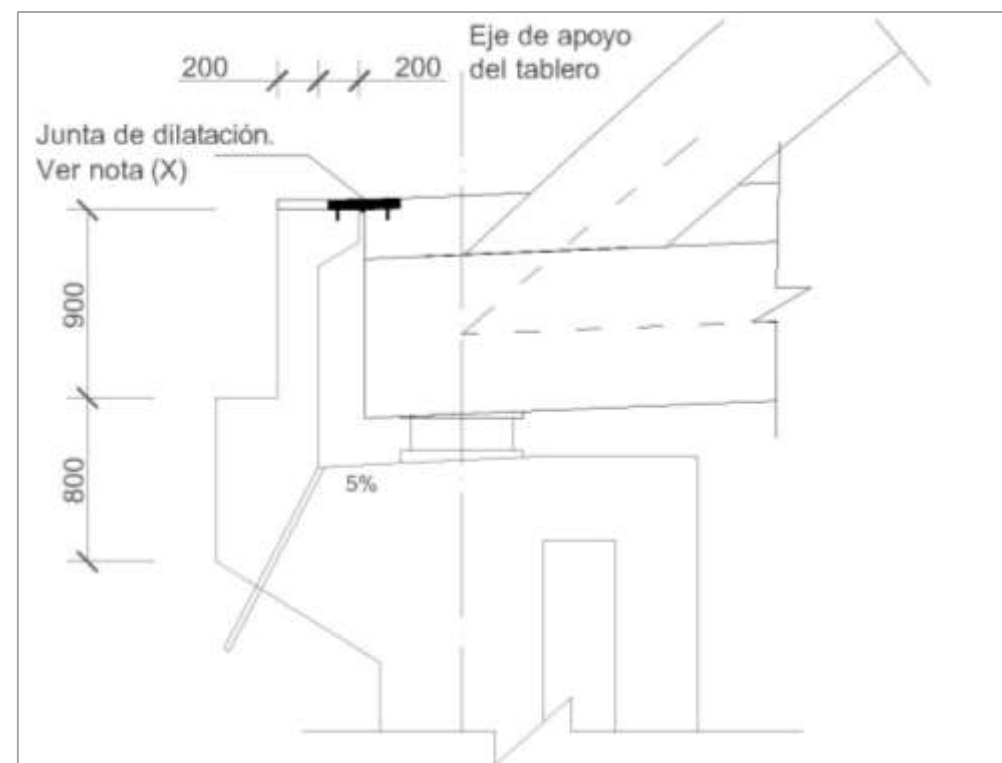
Detalle del apoyo del puente. Fuente: Elaboración propia con AutoCAD.
